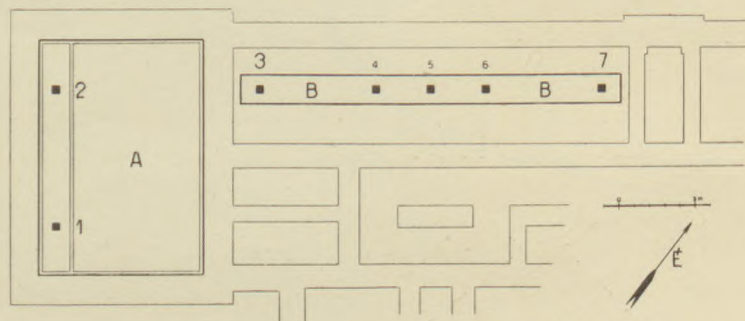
Lageplan der Mauerkörper und der Pfeiler.
